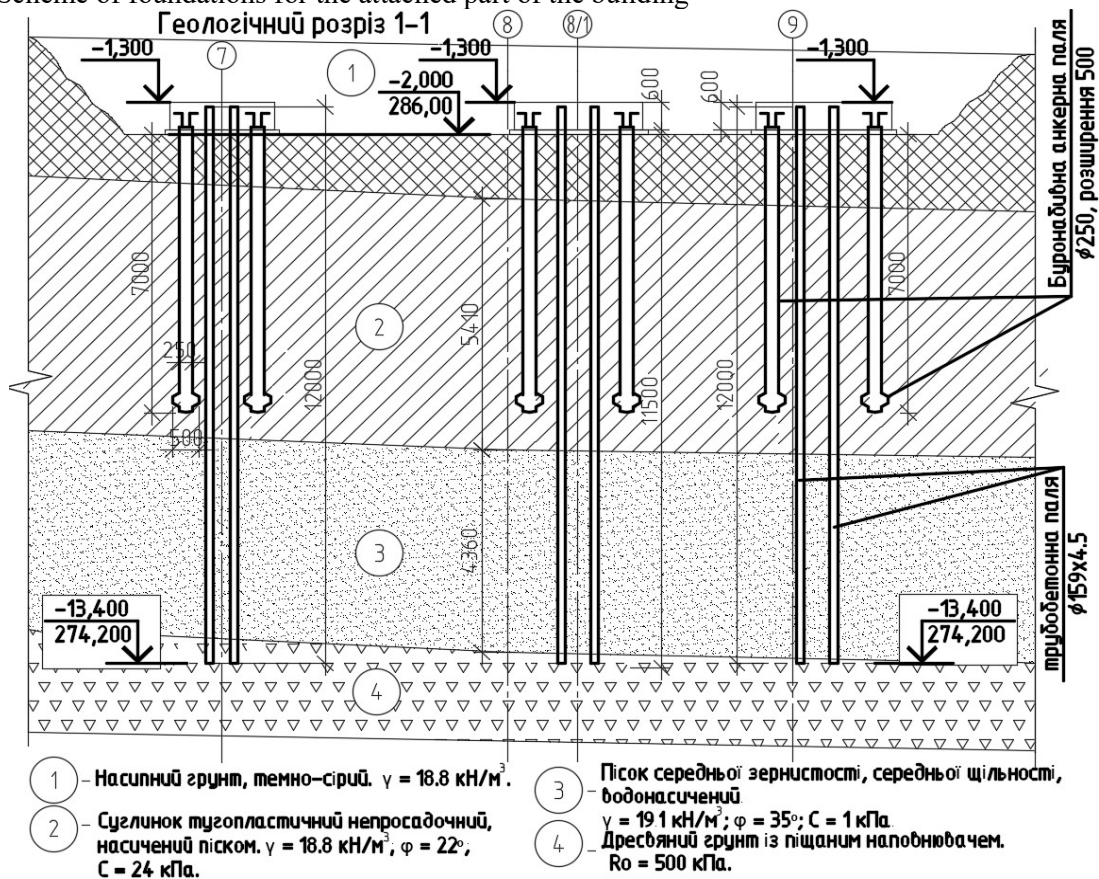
Посадка на геологію фундаментів під прибудовану частину будівлі
